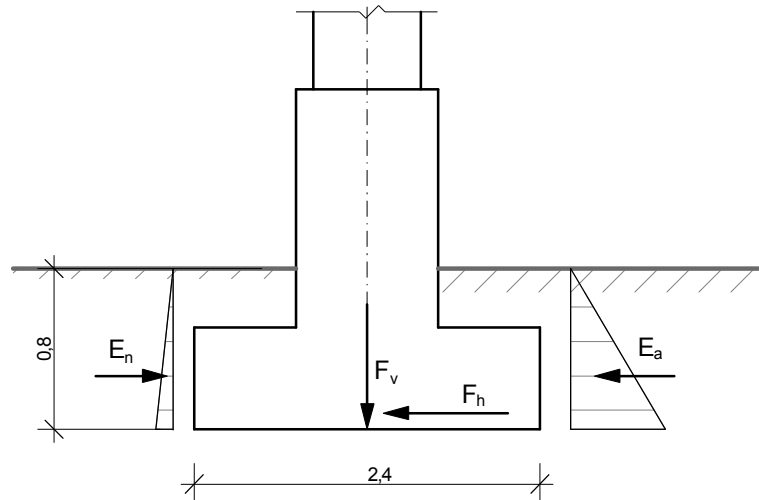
Розрахункова схема для розрахунку фундаменту на зсув по підшві
